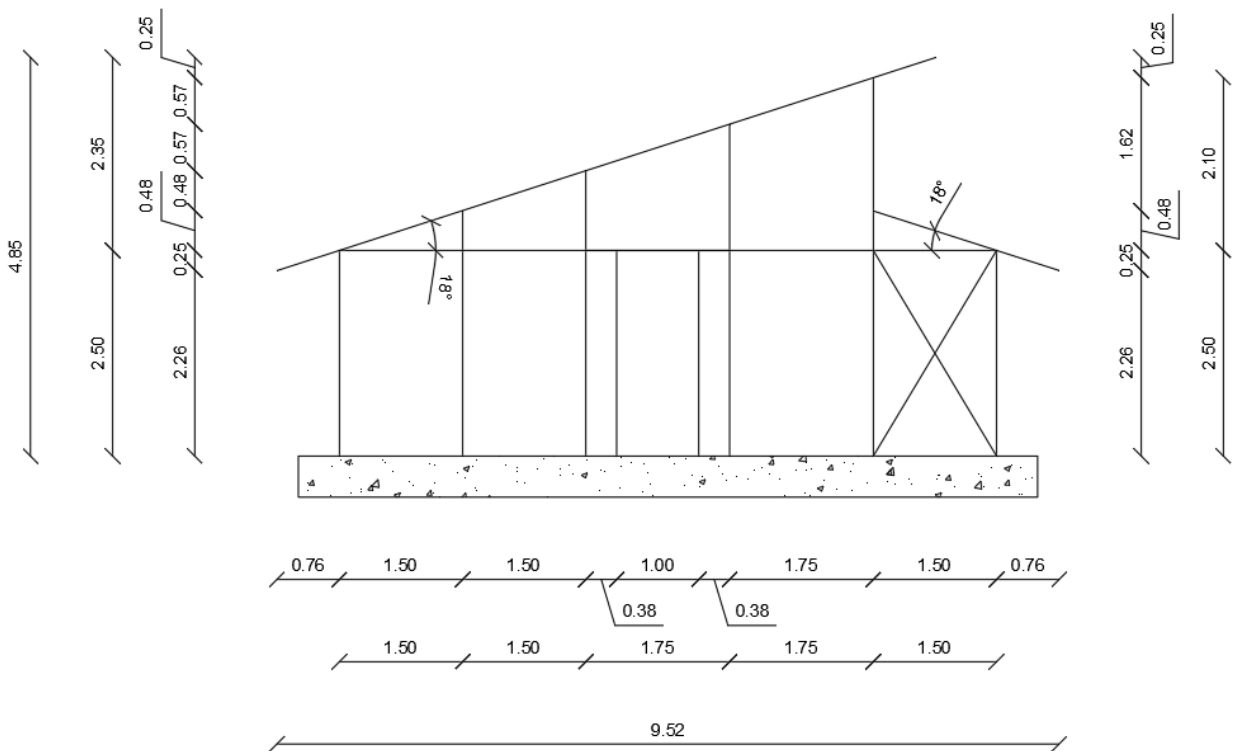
Prospetto Sud dell'edificio a seguito delle modifiche.
